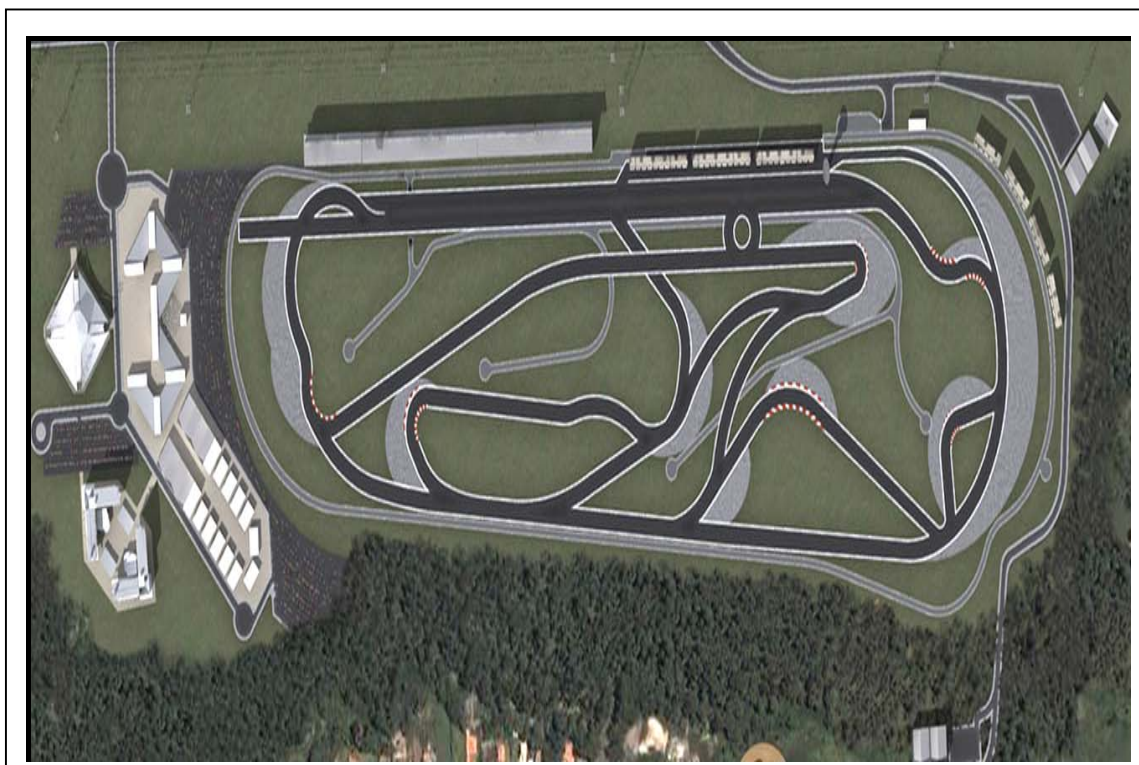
Alternativas de traçado da pista principal
